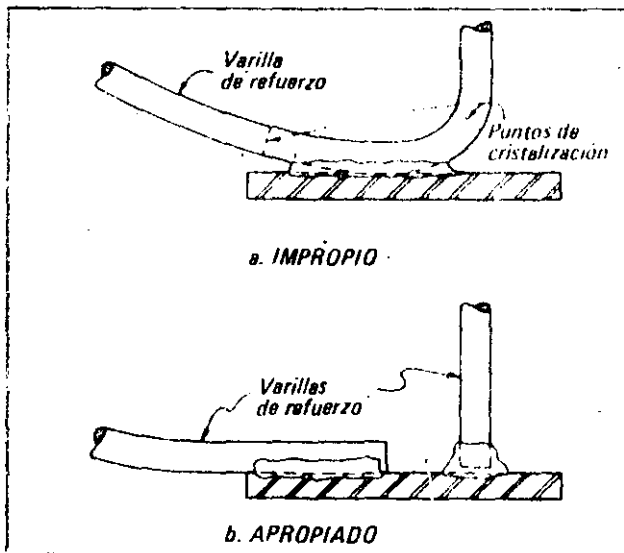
Soldadura de las varillas de refuerzo
